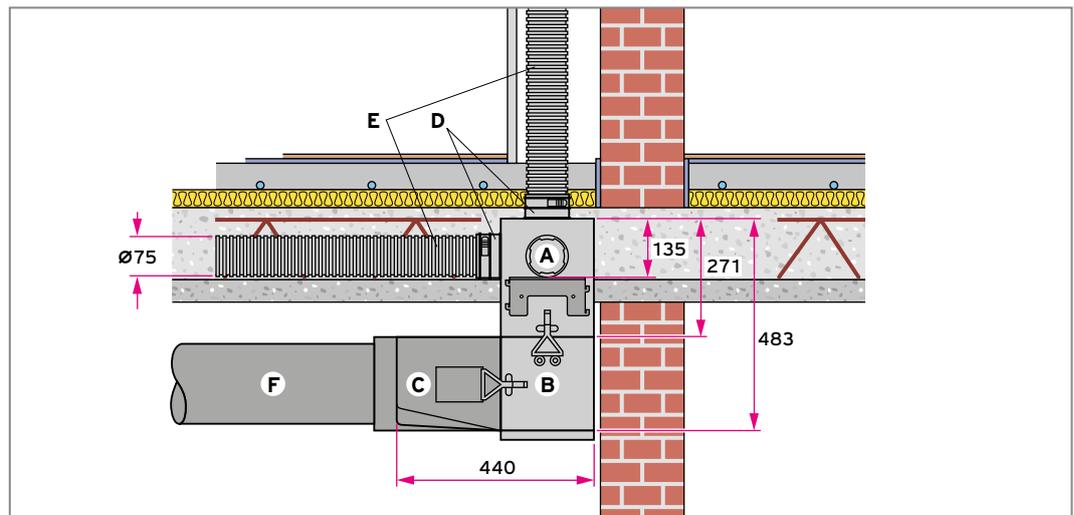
Luftverteiler/-sammler für runde Luftschläuche in der Rohbetondecke, Schnittdarstellung
